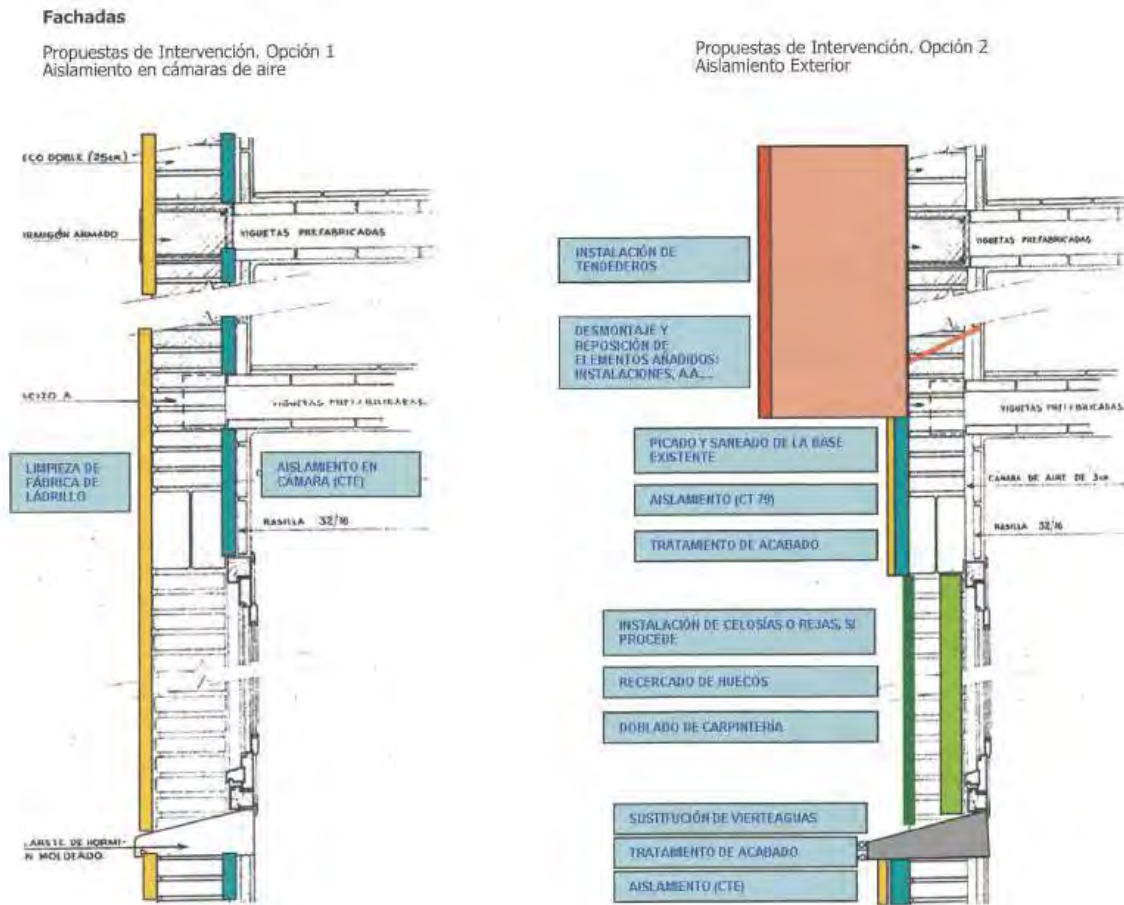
Opciones para la intervención en el aislamiento térmico de fachadas
